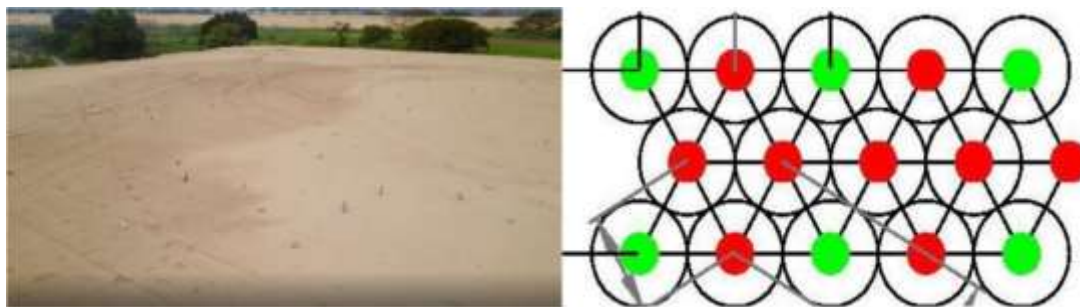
Ejemplo de Drenes verticales (foto archivo)
